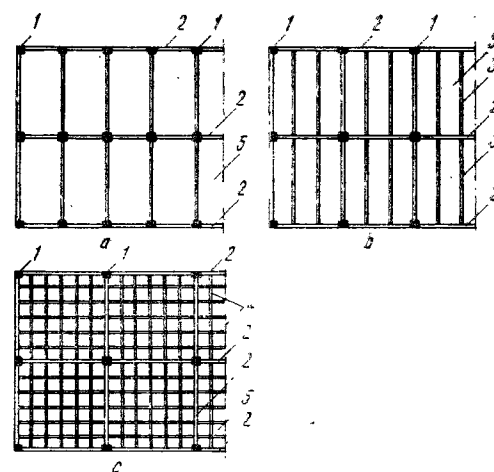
Scheme de planșee monolite la structuri în cadre:
